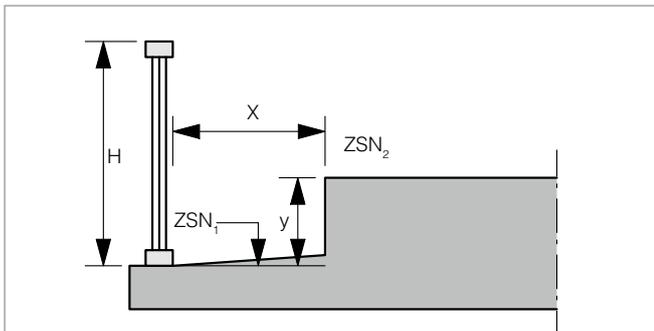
Hauteur de protection des garde-corps en contrebas d'une zone de stationnement ou de circulation.
